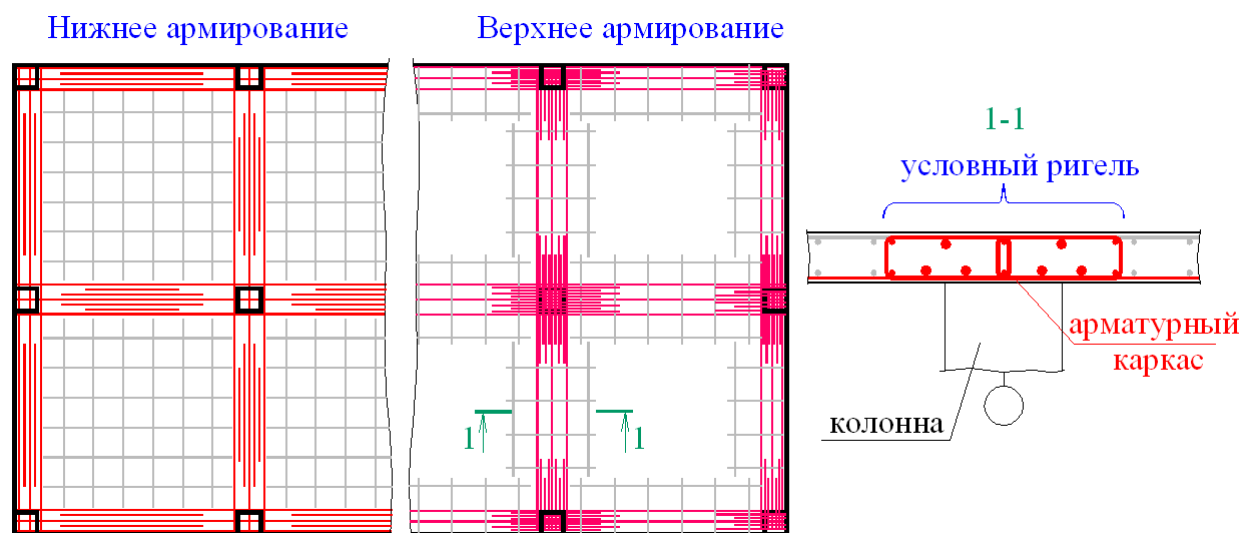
Концентрированное «ригельное» армирование плоских плит пространственными каркасами
